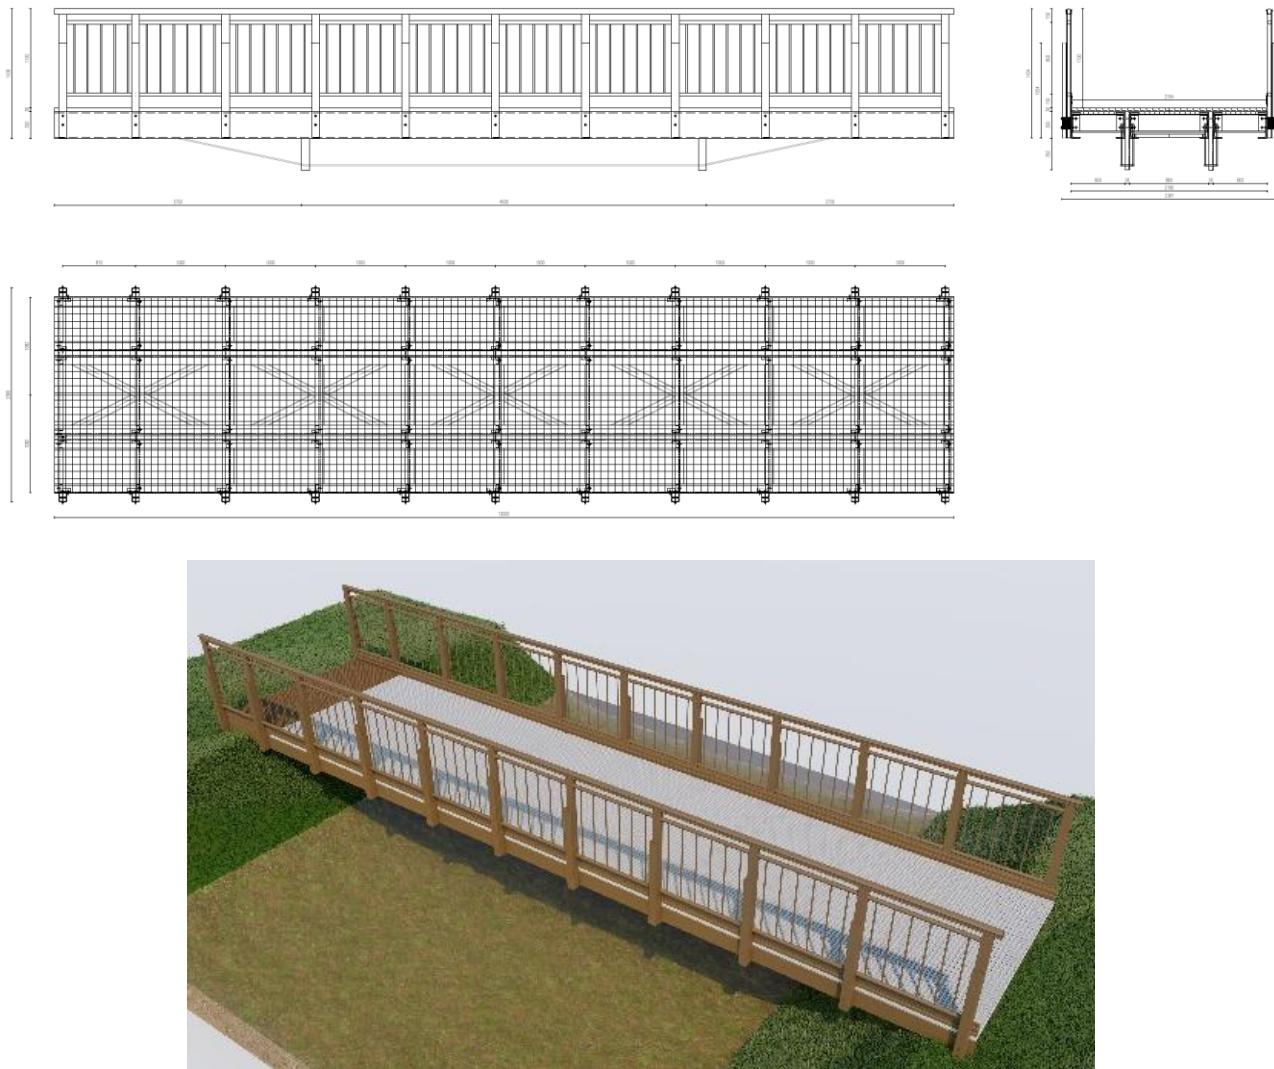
Pianta, prospetto, sezione e possibile installazione della passerella per luci fino da 6 a 10 m
